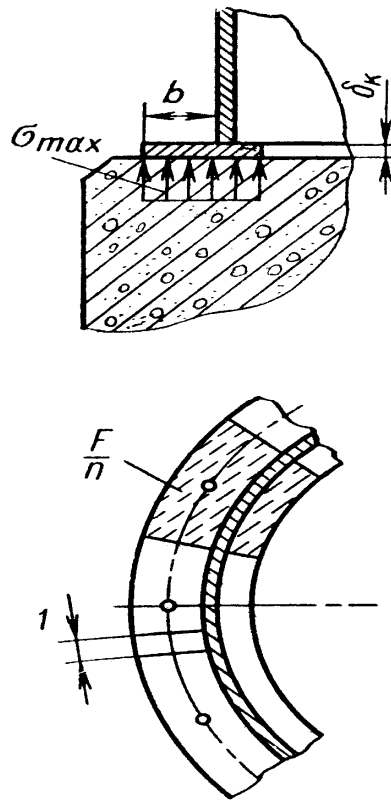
Схема к расчету нагрузки на фундаментное кольцо.
